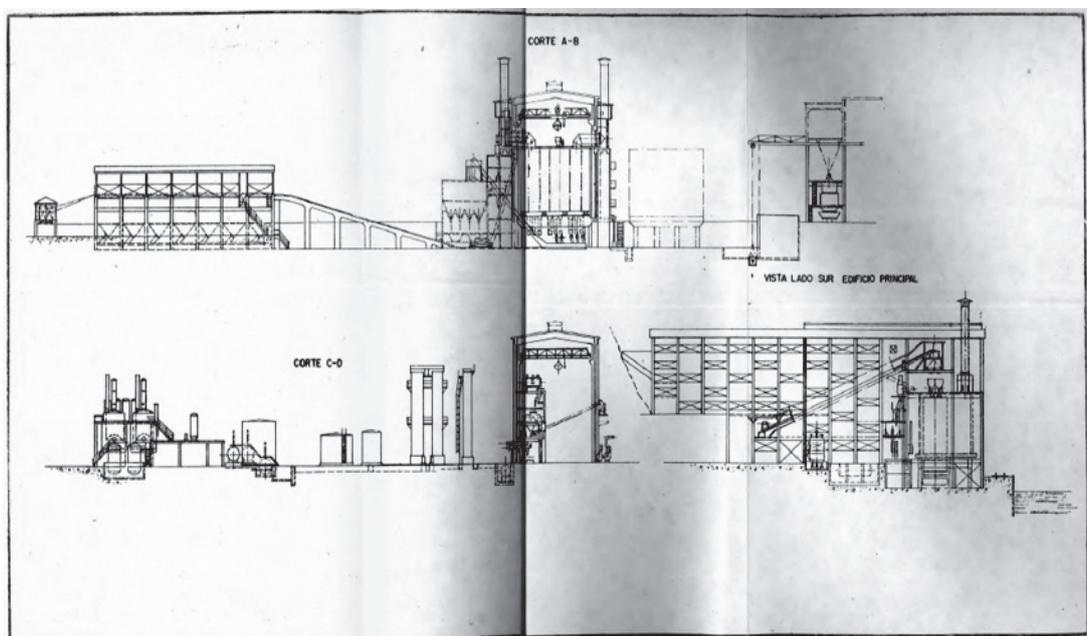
[Fotografía de planos] Plano del proyecto de la Planta purificadora de carbón.
